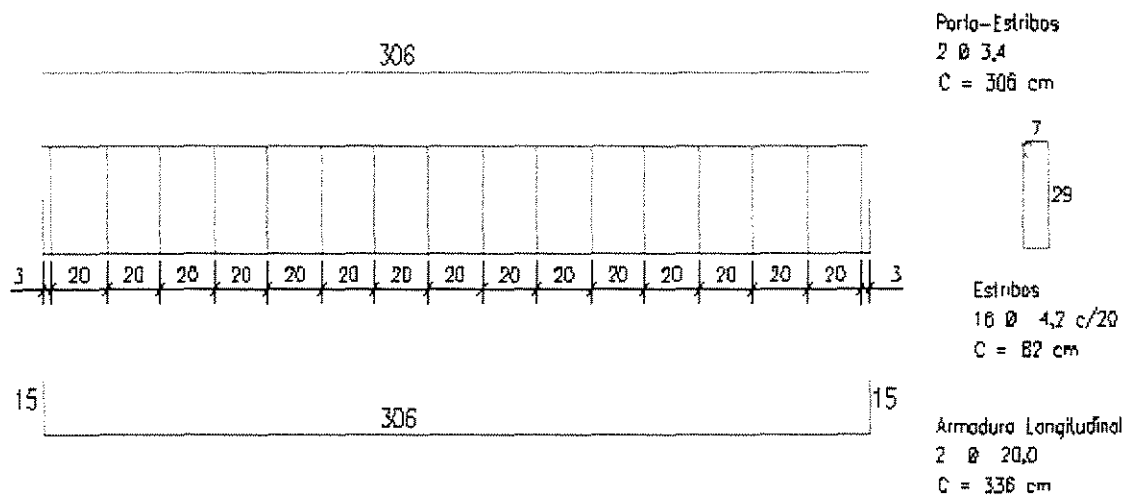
DETALHE DE ARMADURAS - VIGA 2BL-CIS
